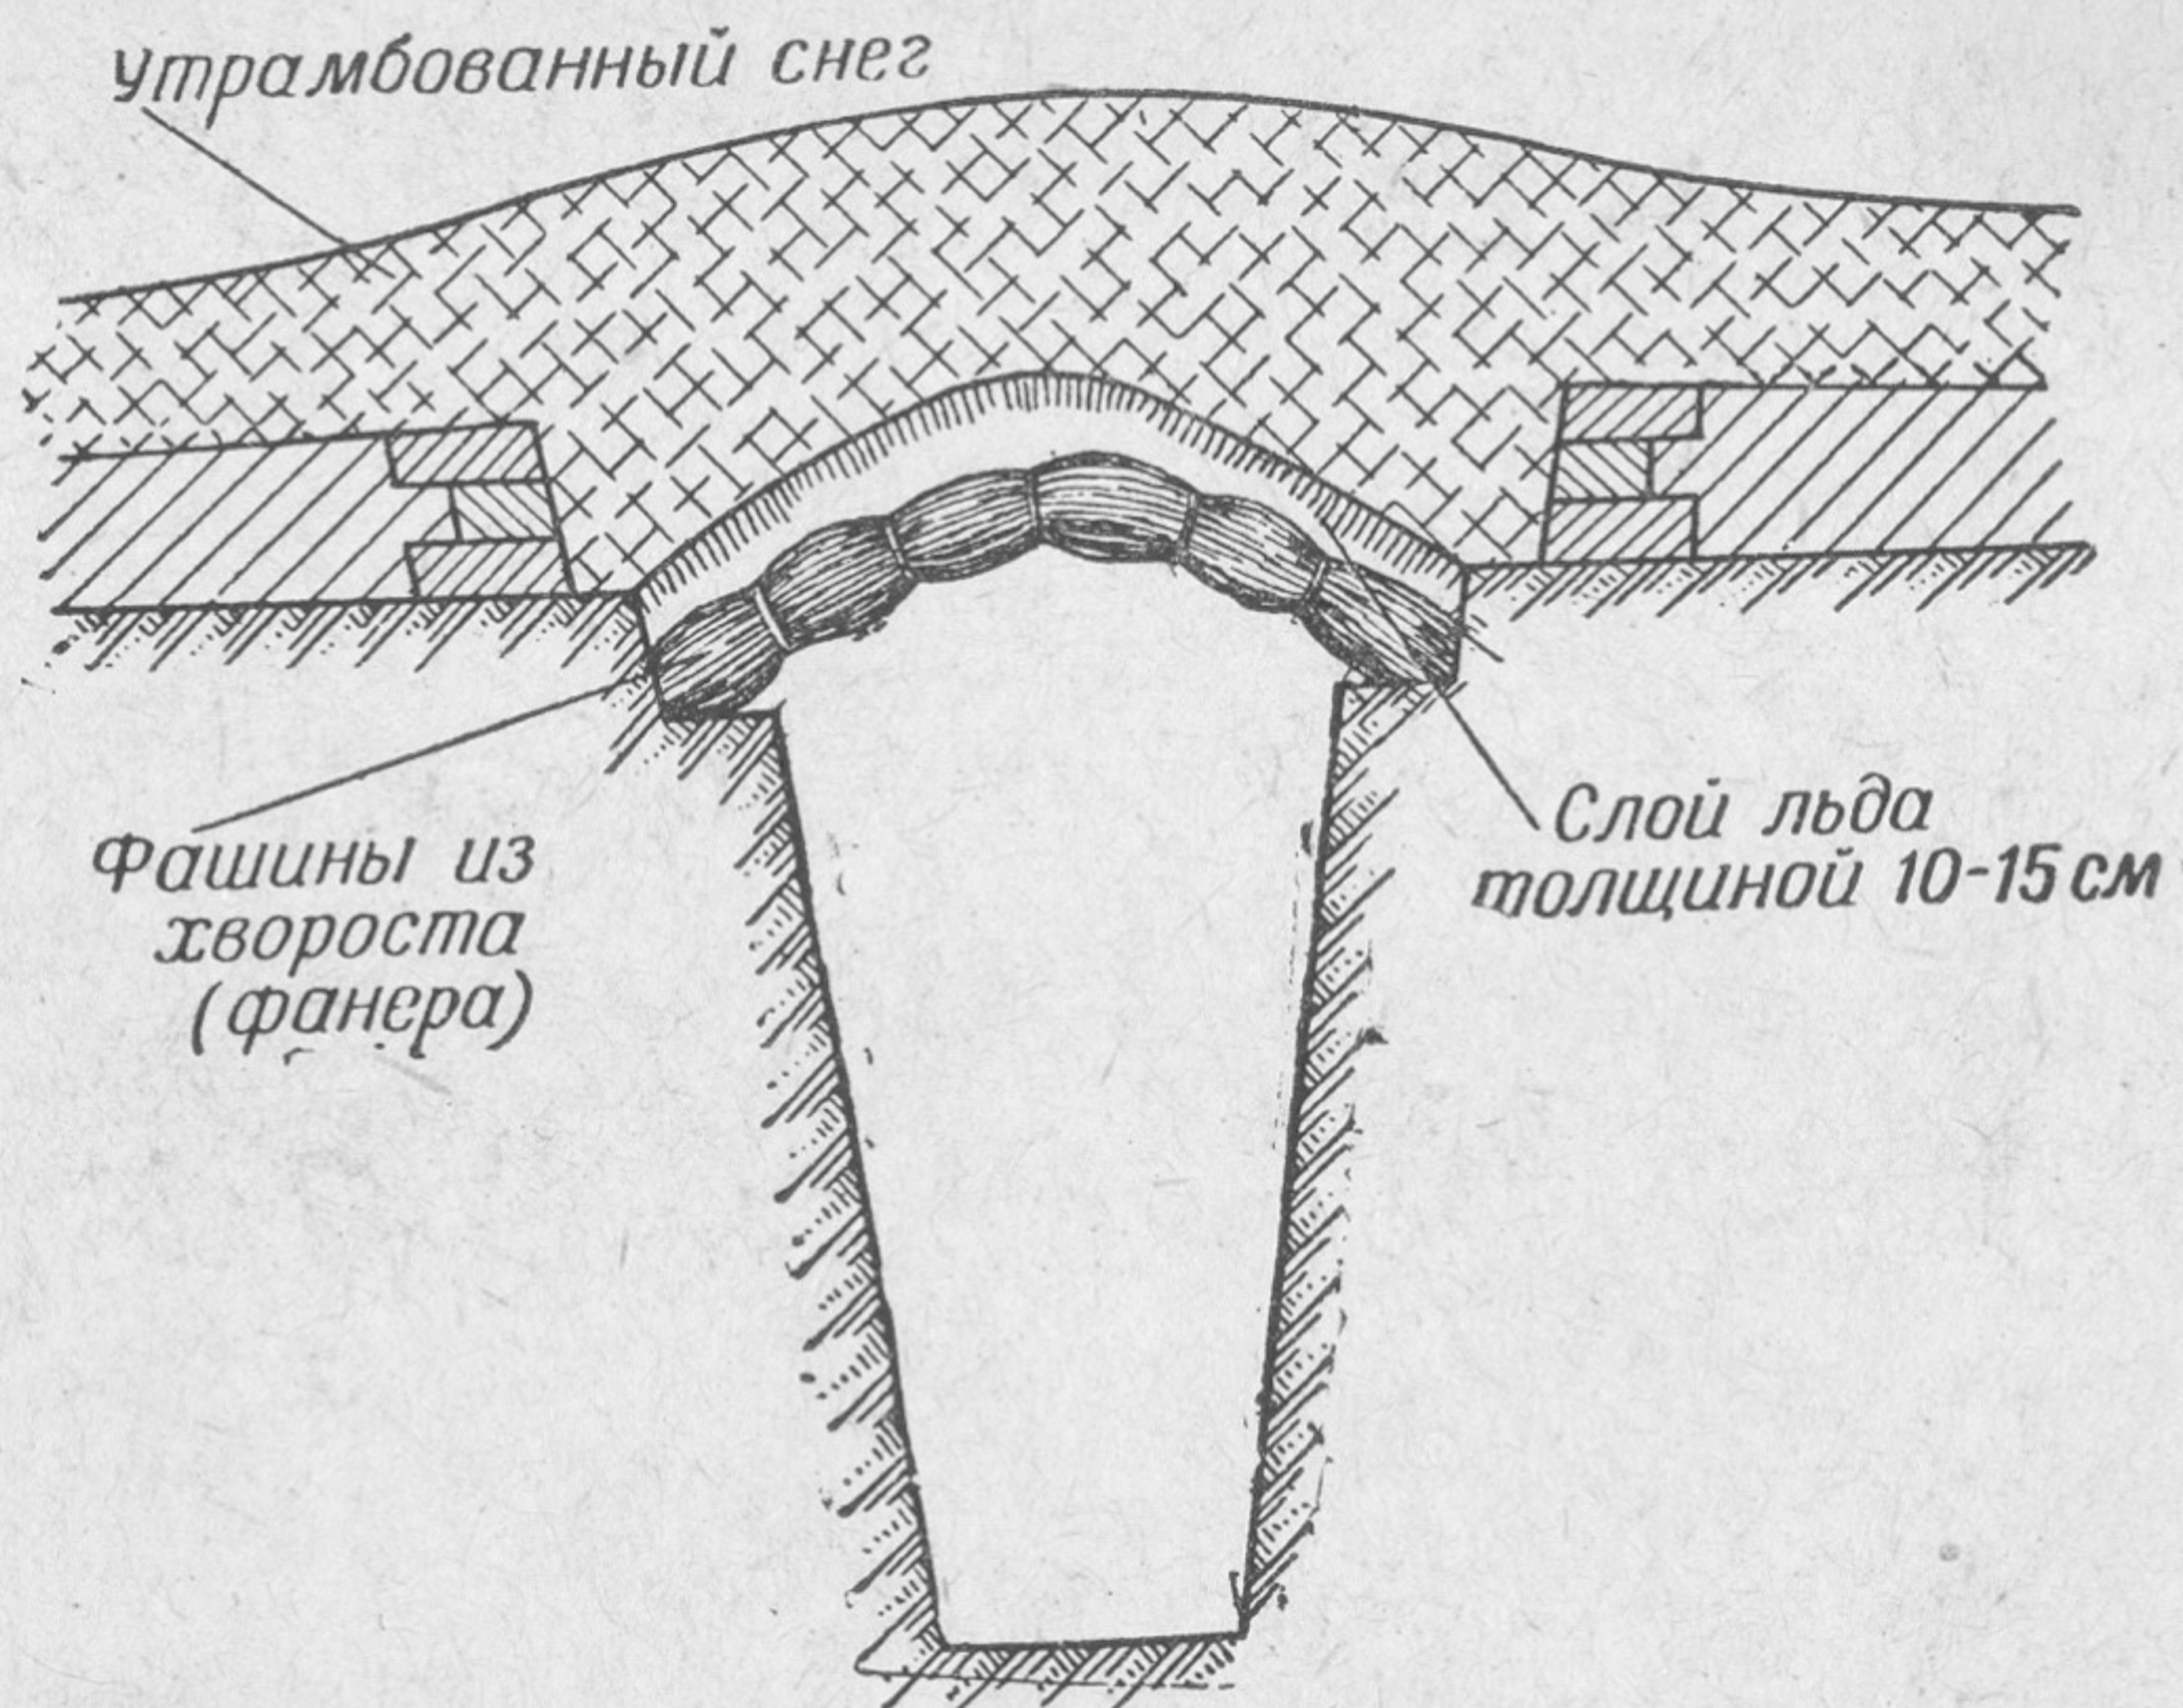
Перекрытие траншеи или окопа, сделанное из снега
